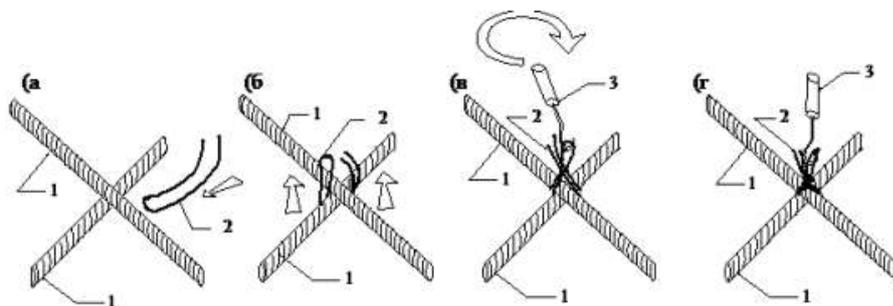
Схема фиксации арматурных стержней вязальной проволокой: а) продергивание проволоки под узлом; б) выравнивание концов проволоки; в) скручивание концов проволоки вязальным крюком; г) зафиксированный узел: 1 – арматурный стержень
